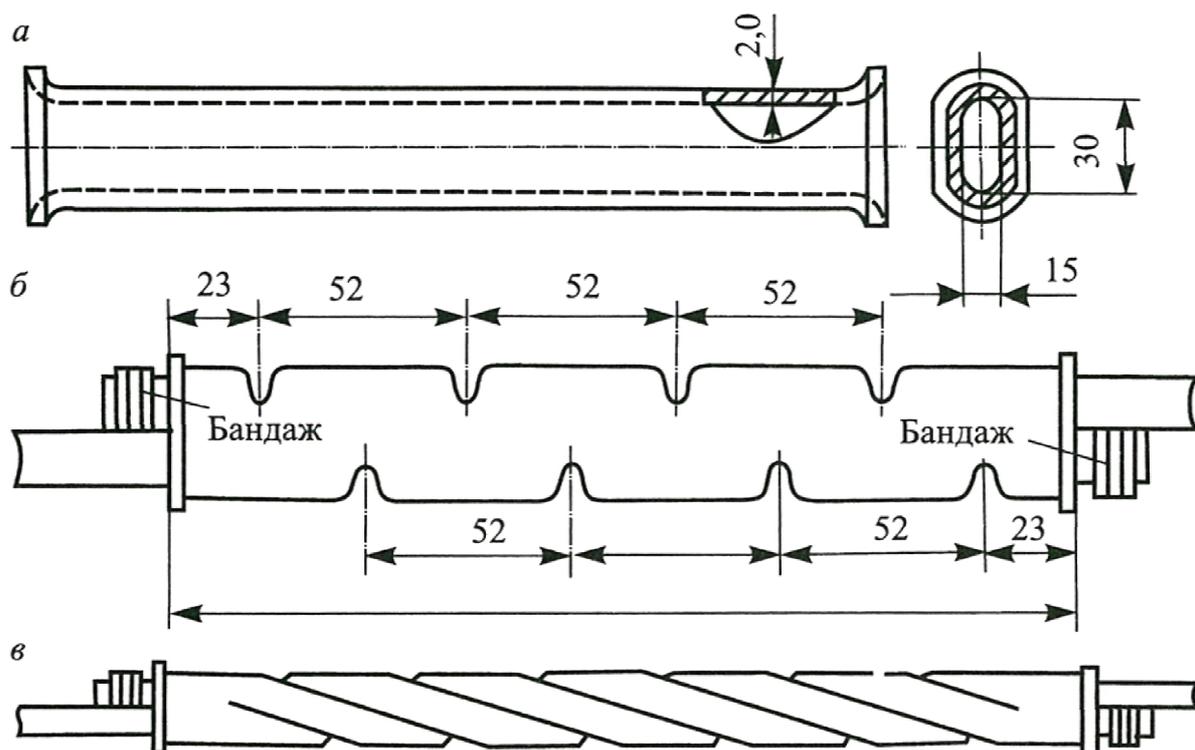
Общий вид трубчатых овальных соединителей (а) и схемы соединения проводов методами опрессовки (б) и скручивания (в) соединителей
